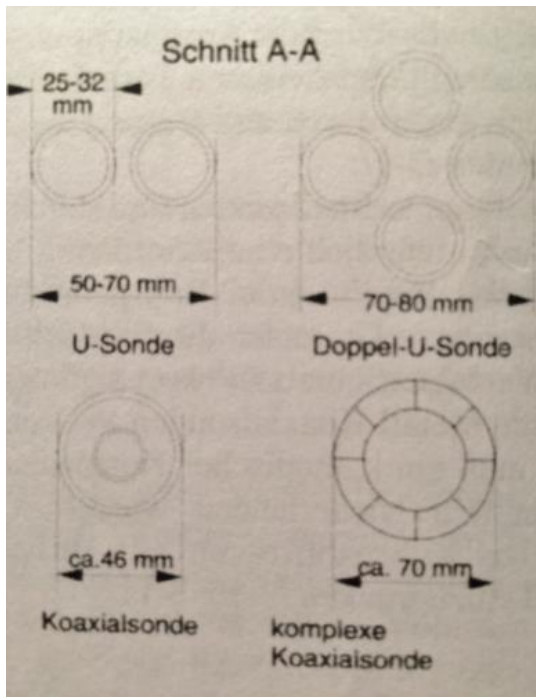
Dimensionierung im Querschnitt⁹⁶
